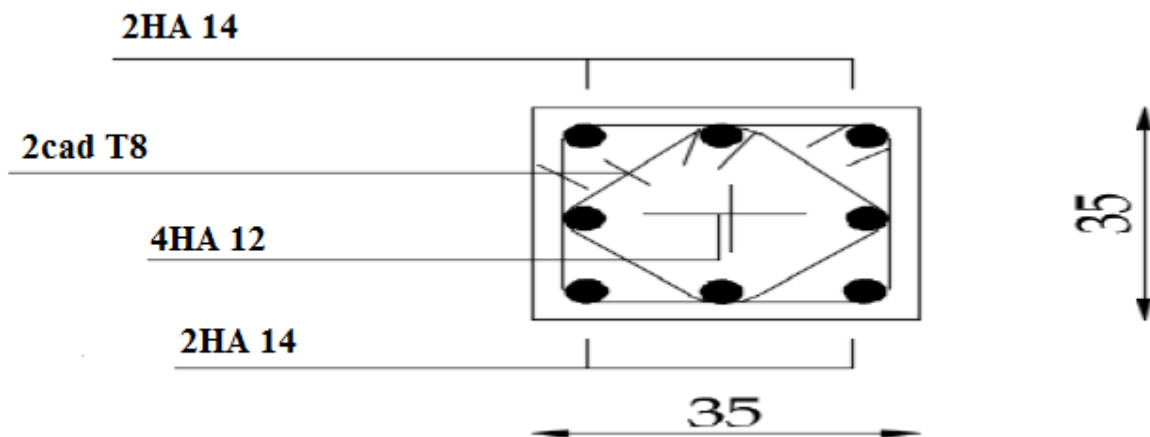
Schéma de ferrailage des poteaux (35 × 35)
